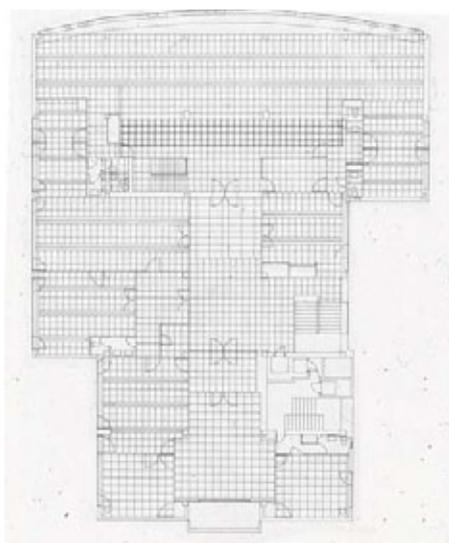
Plano de techos de planta, propuesta de Sota y Llinás, restauración. Josep Llinás.
